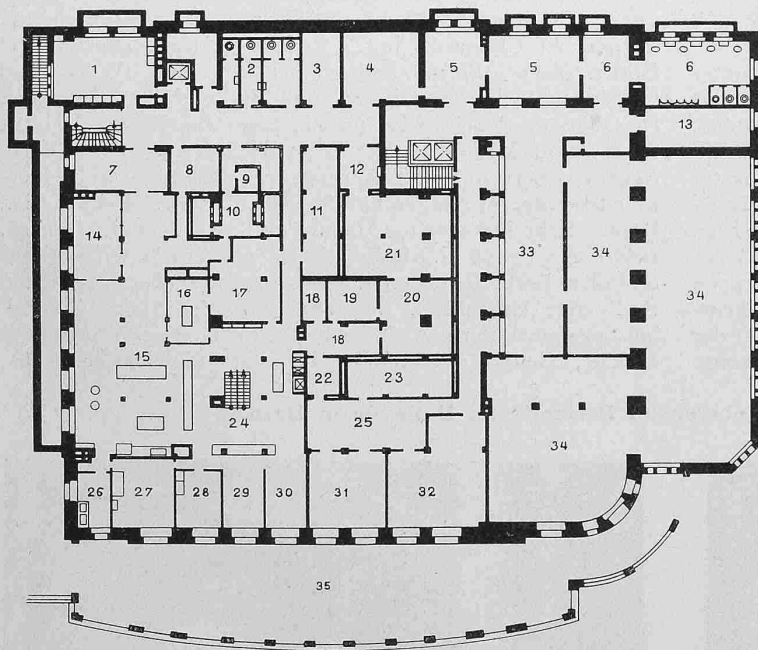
Erstes Untergeschoss. — Masstab 1 : 600.
